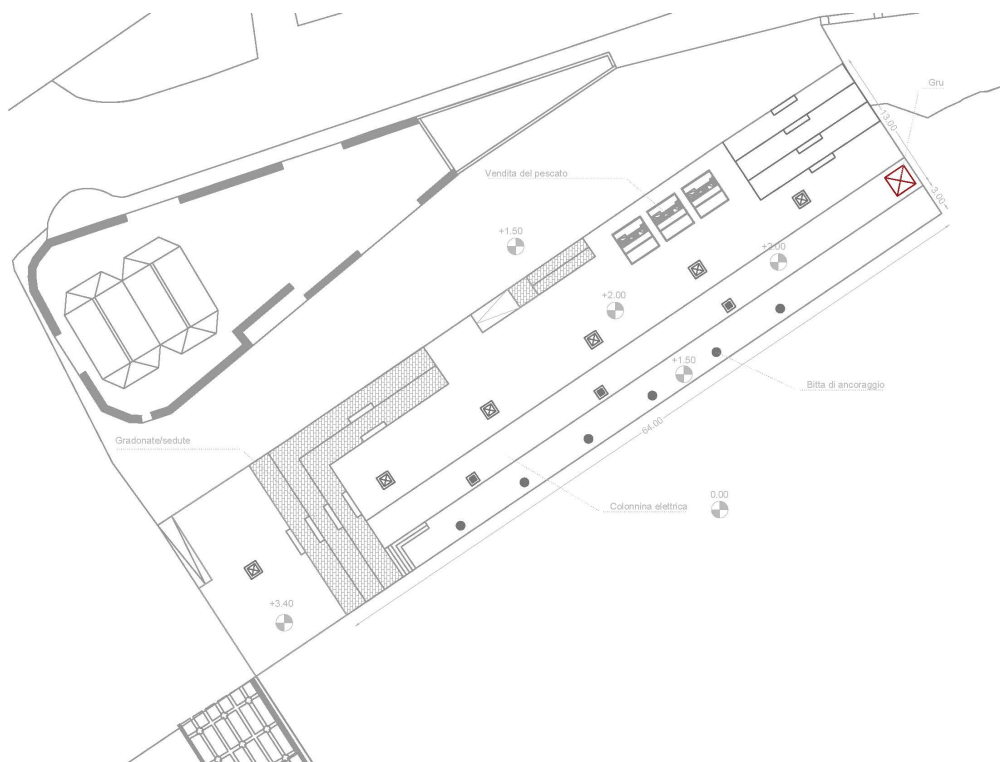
Planimetria di progetto con ottimizzazione dell'area di intervento.
